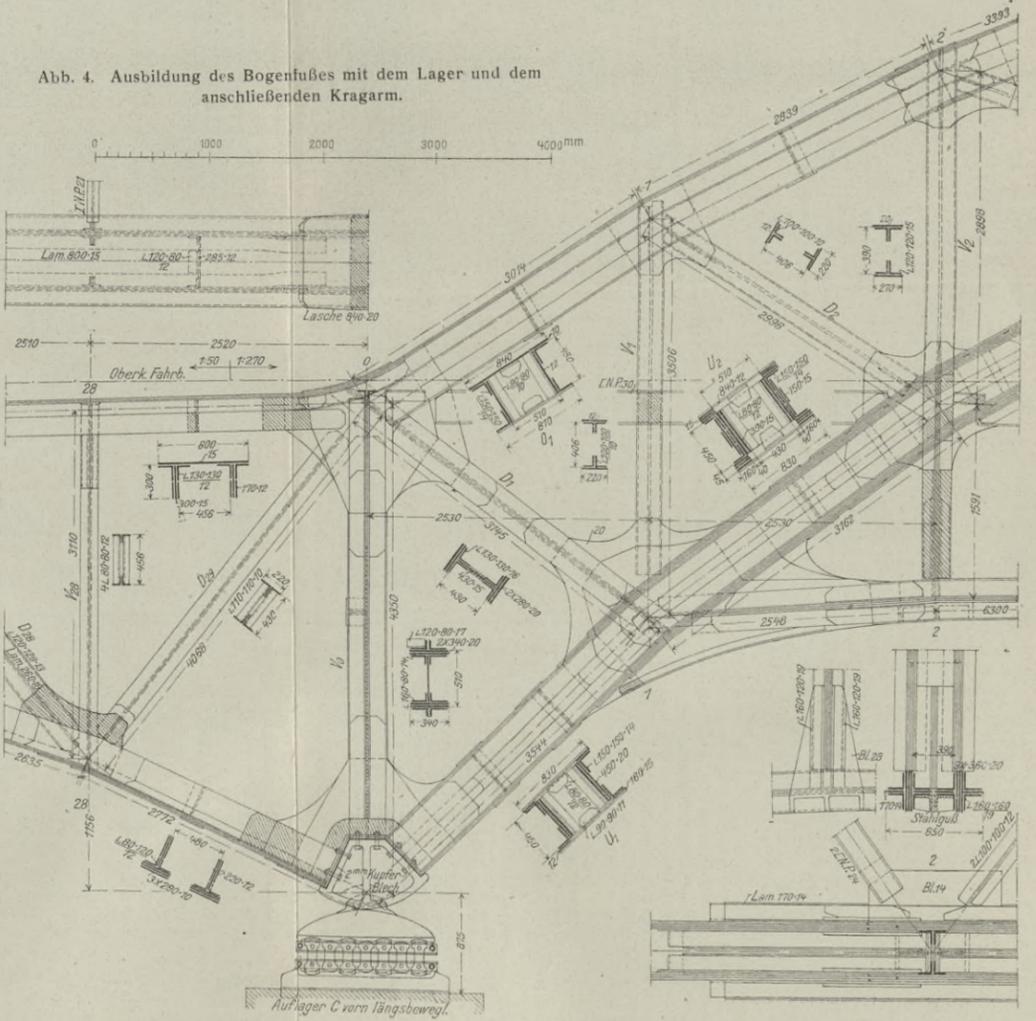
Ausbildung des Bogenfußes mit dem Lager und dem anschließenden Kragarm.
